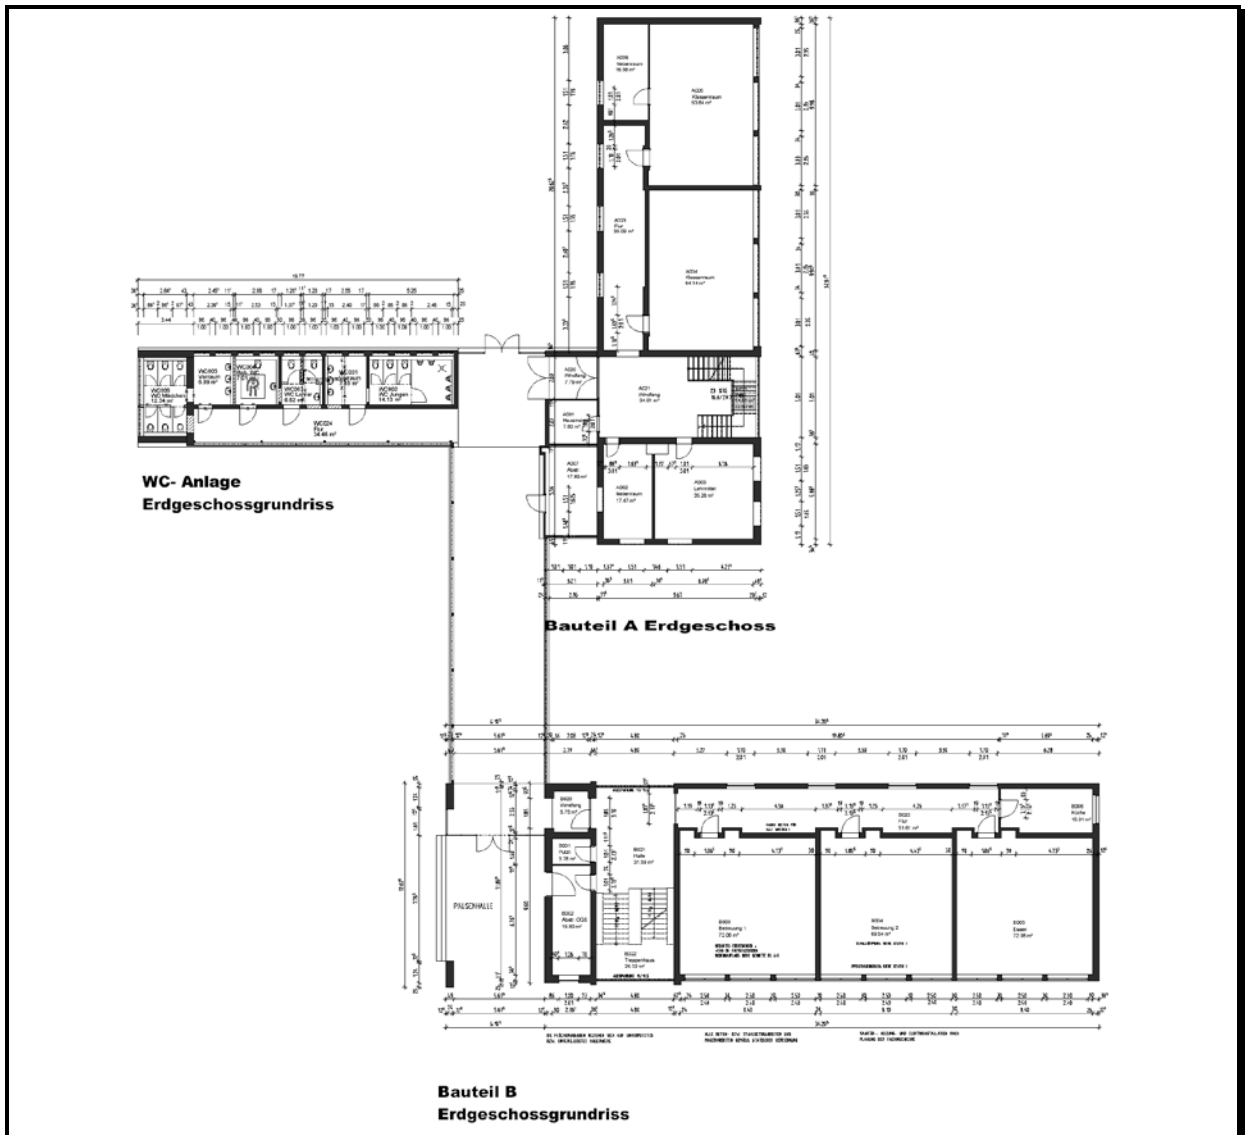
Carl-Orff-Schule: Grundriss Erdgeschoss; Bauteil A und B
